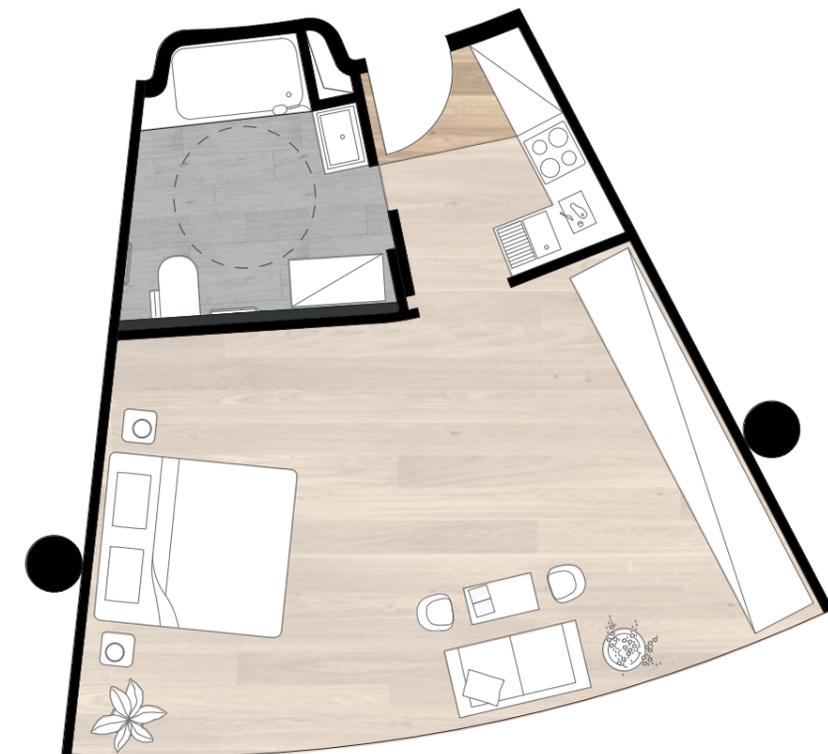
Grundriss für Senioren Pärchen (eigener Plan)
